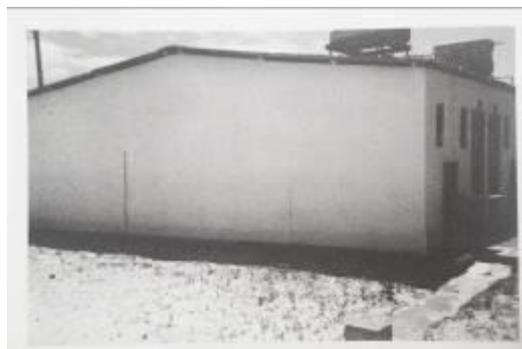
fissura em parede externa, promovida pela retração em laje
